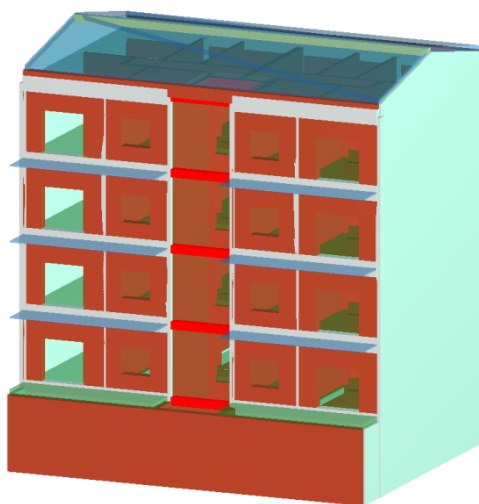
Esquema representativo da introdução do reforço da viga de contraventamento na fachada principal
